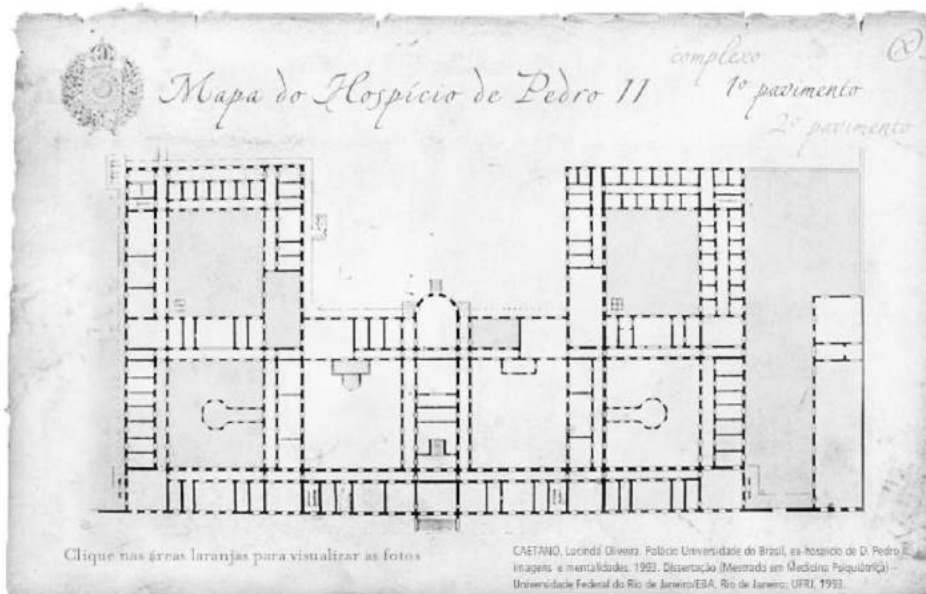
Planta do 1º pavimento do Hospício Pedro II.
